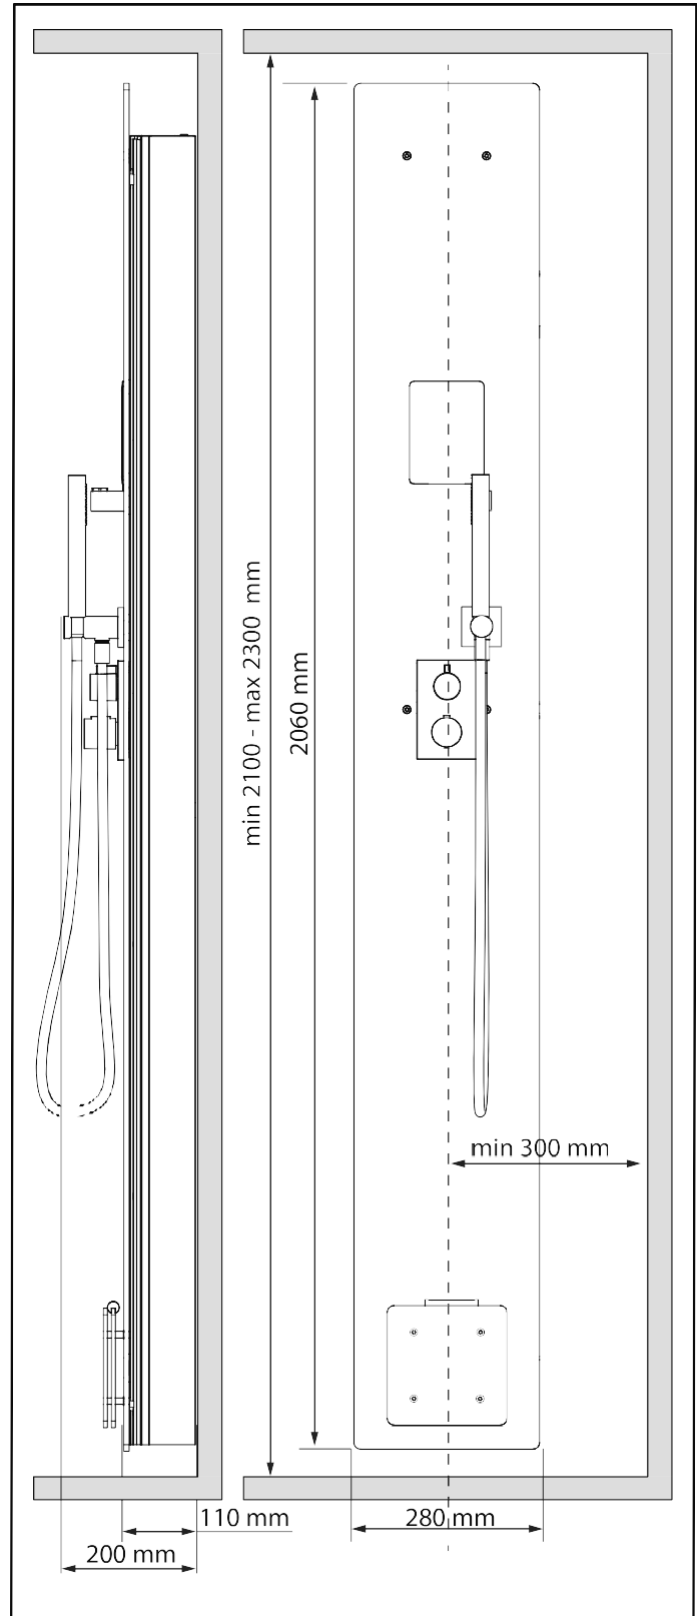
Dimensioni in millimetri, colonna vapore tipo Stella
